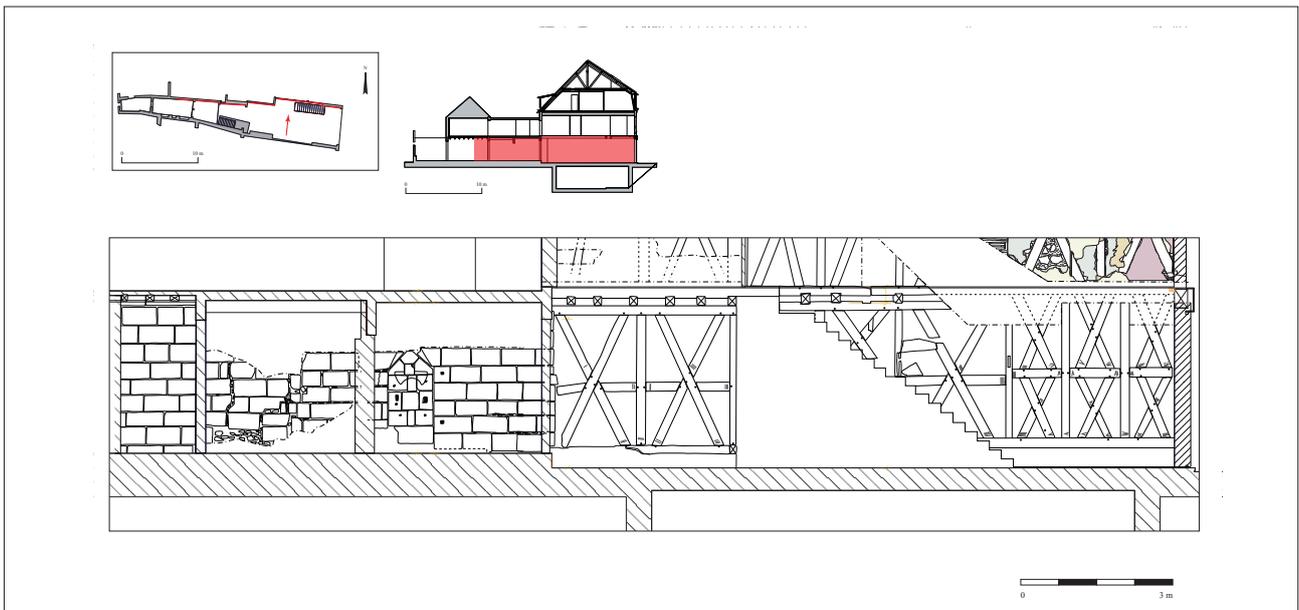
Elévation du mur nord au niveau du rez-de-chaussée avec les principaux composants archéologiques (relevé S. Bryant, Inrap et A. Prévot, Inrap).
